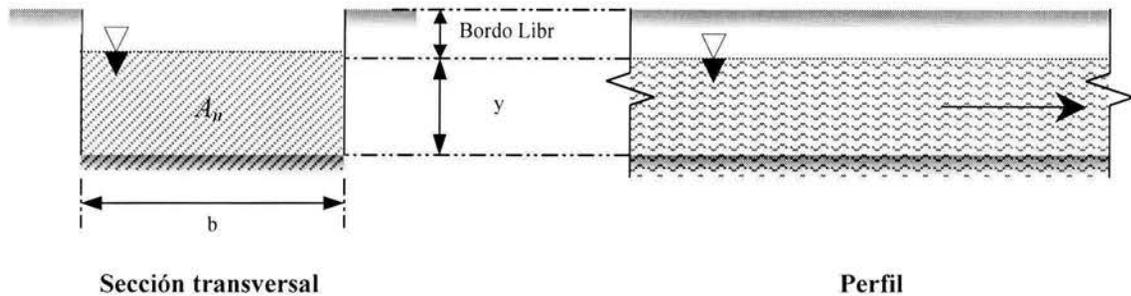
Sección transversal y perfil de un canal rectangular
